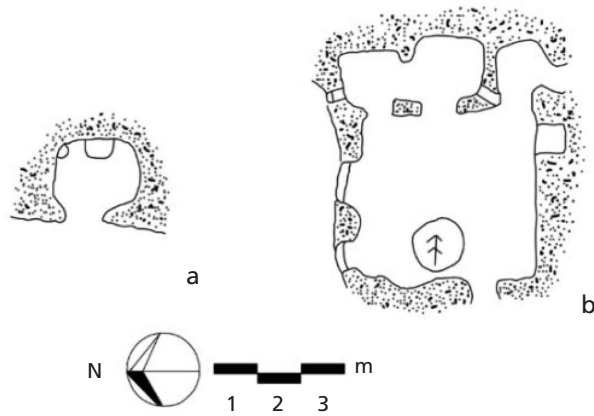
Tūr 'Abdīn, Ḥabis I. a Gebetsraum. – b Eremitenklaue, Grundriss. – (Nach Wießner, *Christliche Kultbauten* 3, Fig. 20).
